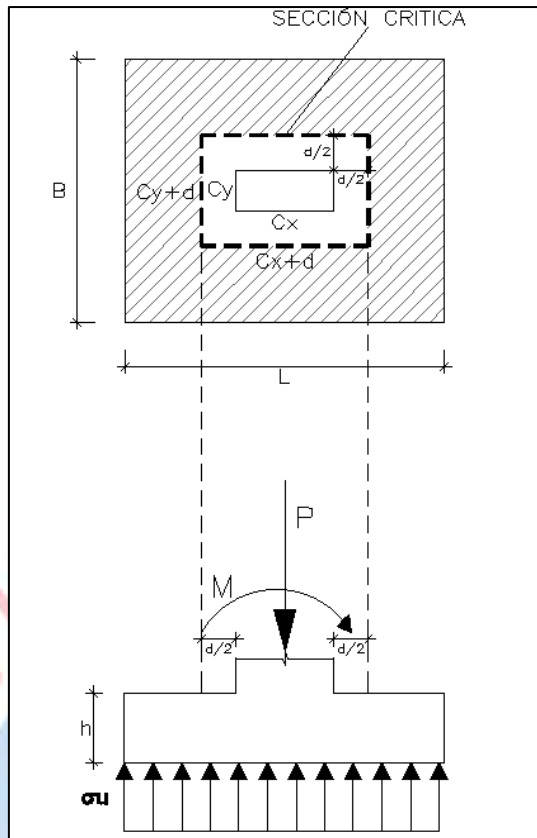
Sección crítica para verificación de corte por punzonamiento.
